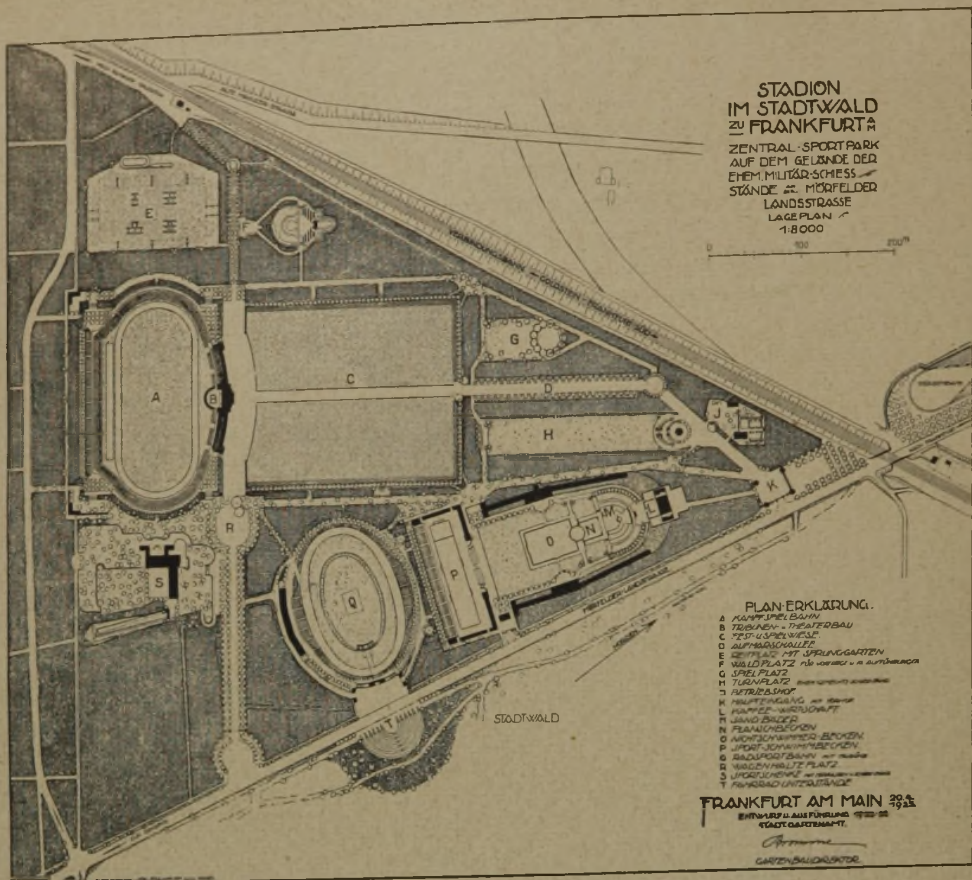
Gesamtlageplan des Stadion im Stadtwald. (1 : 8000.)
